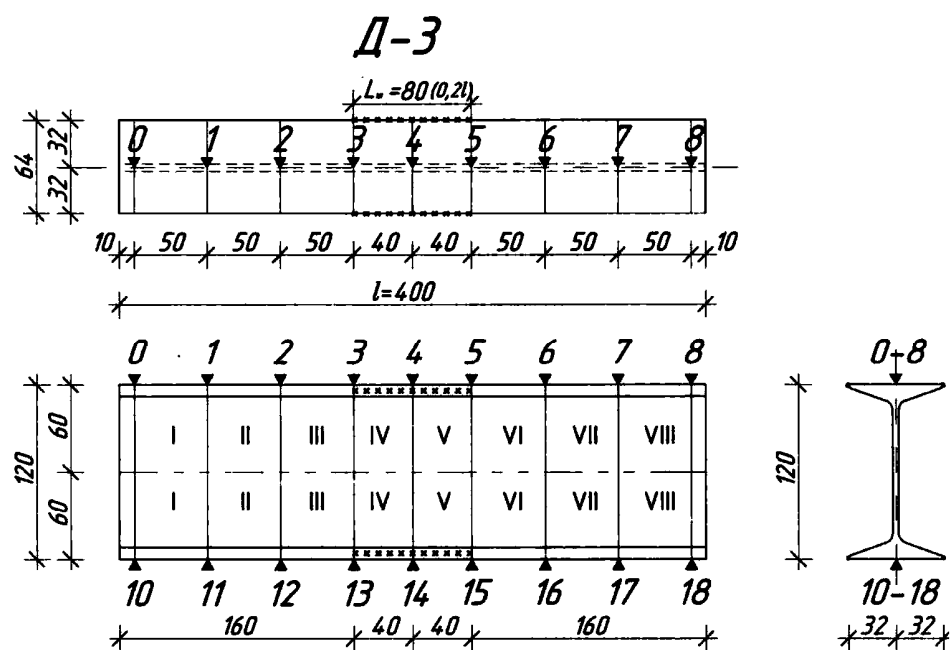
Схема наплавления сварных валиков в образце Д-3
